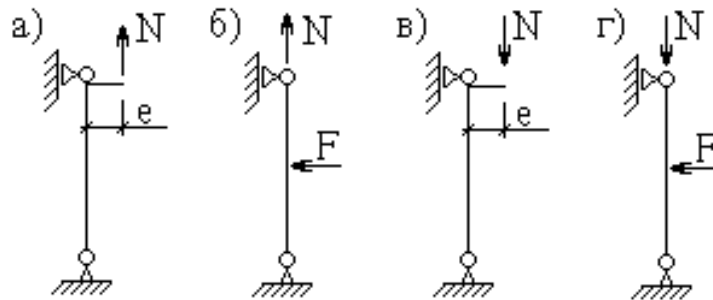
Розрахункові схеми позacentрово навантажених елементів
